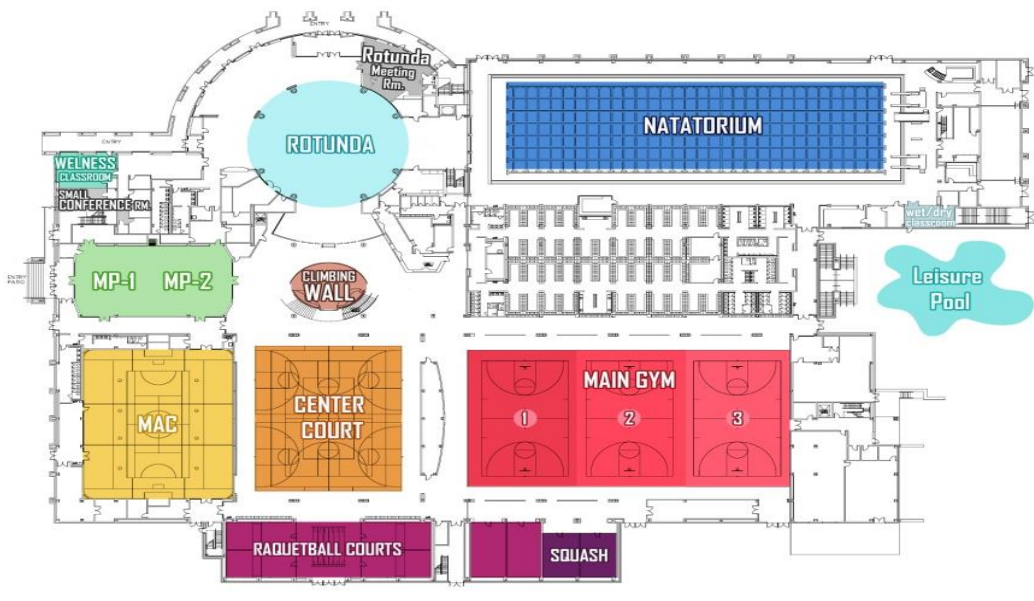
PLANTA BAJA, CENTRO DE RECREACIÓN Y BIENESTAR CAMPUS UNIVERSIDAD DE HOUSTON.
